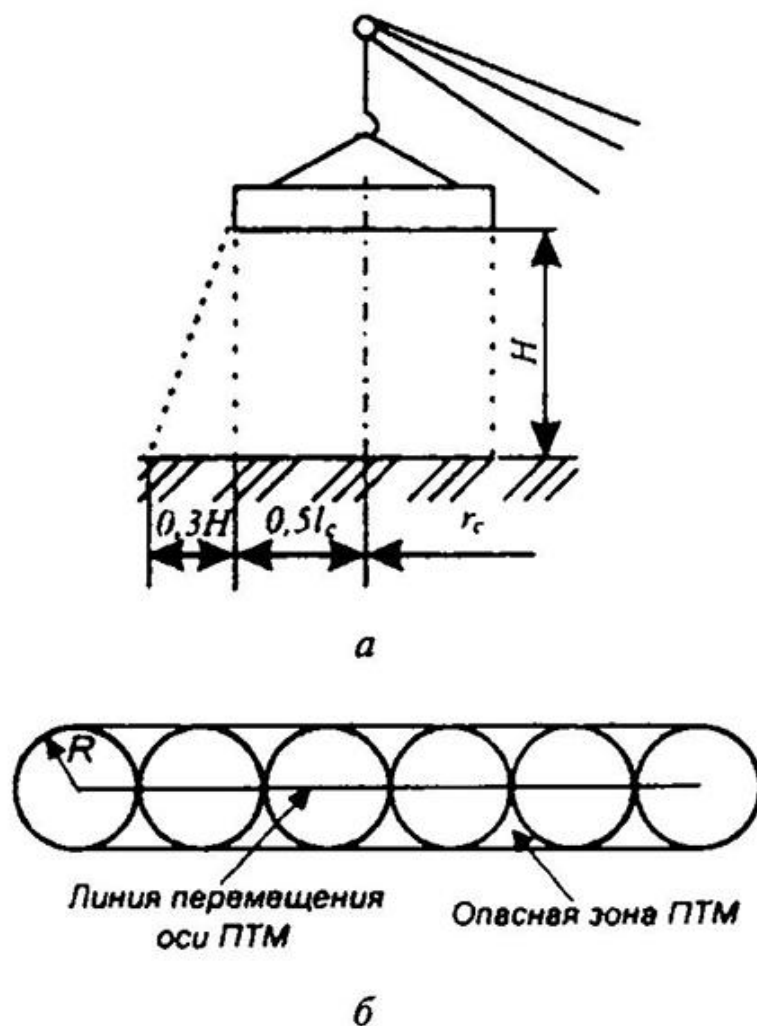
Схема к определению опасной зоны у грузоподъемного механизма:
